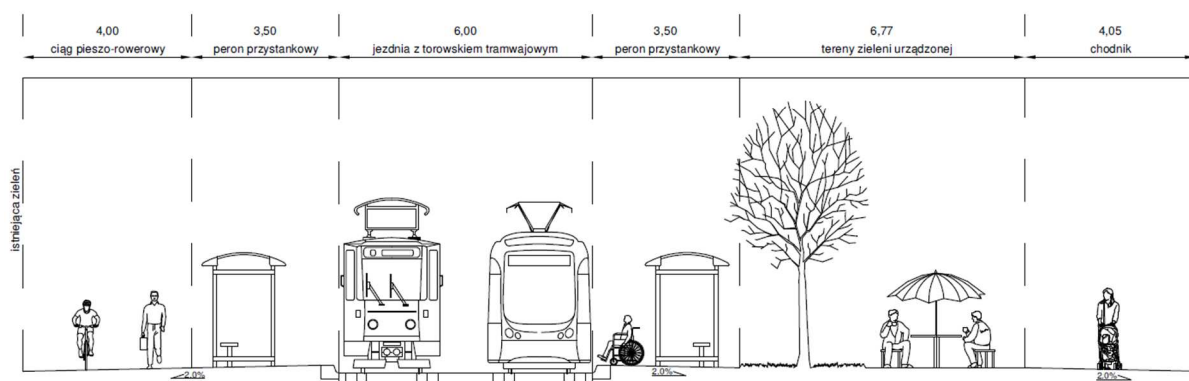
Przekrój konstrukcyjny B-B ul. Podzamcze
